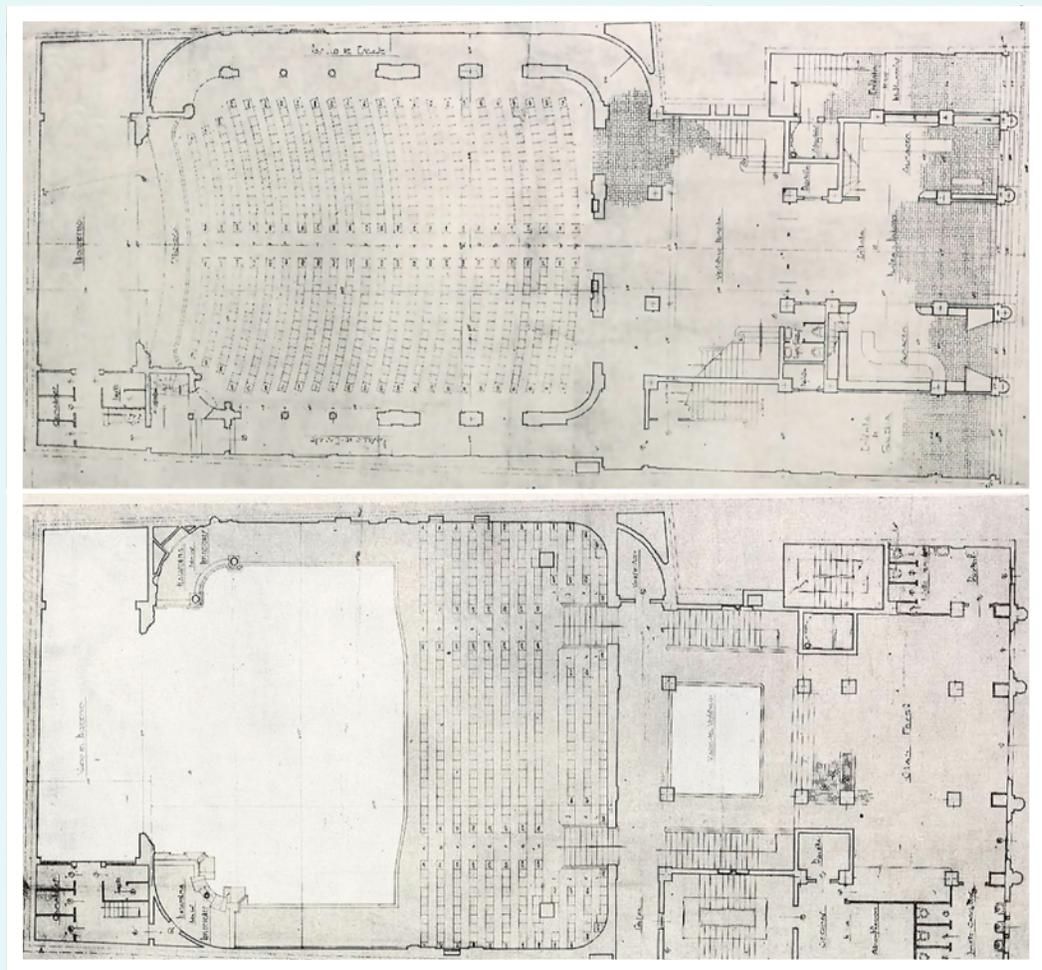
Teatro Real, Planta de Platea Baja (arriba) y Platea Alta (abajo) Fuente: Plantas de los Arquitectos Valdivieso y De la Cruz, *Arquitectura y Arte Decorativo*, n.º 2 (septiembre de 1931): 66-74.
